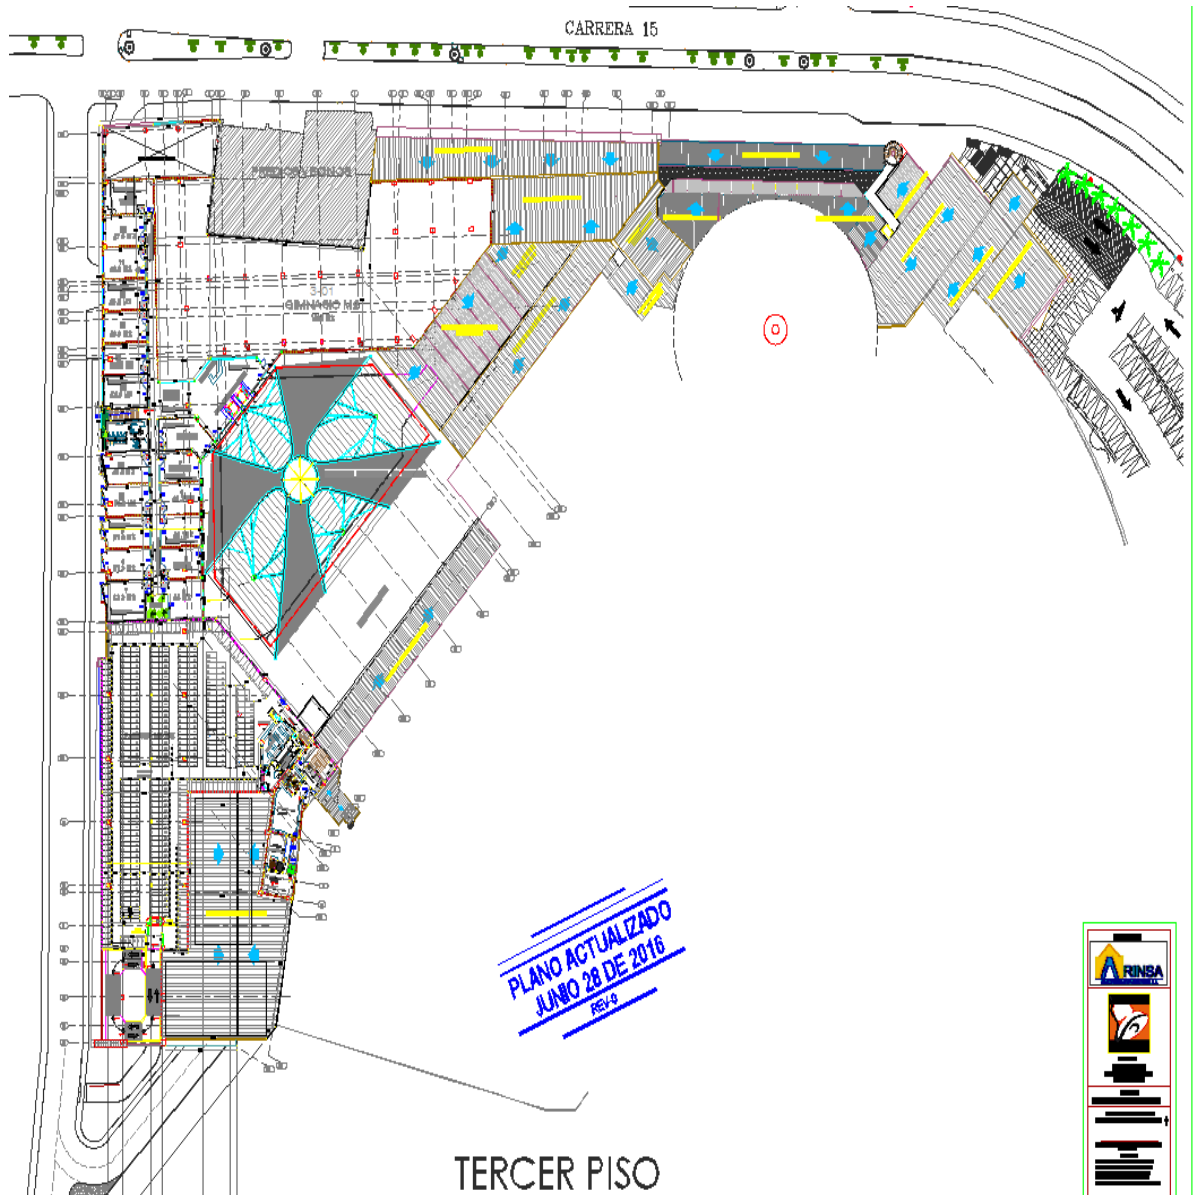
Planta arquitectónica de tercer piso (Fuente: Diseños arquitectónicos ARINSA)
